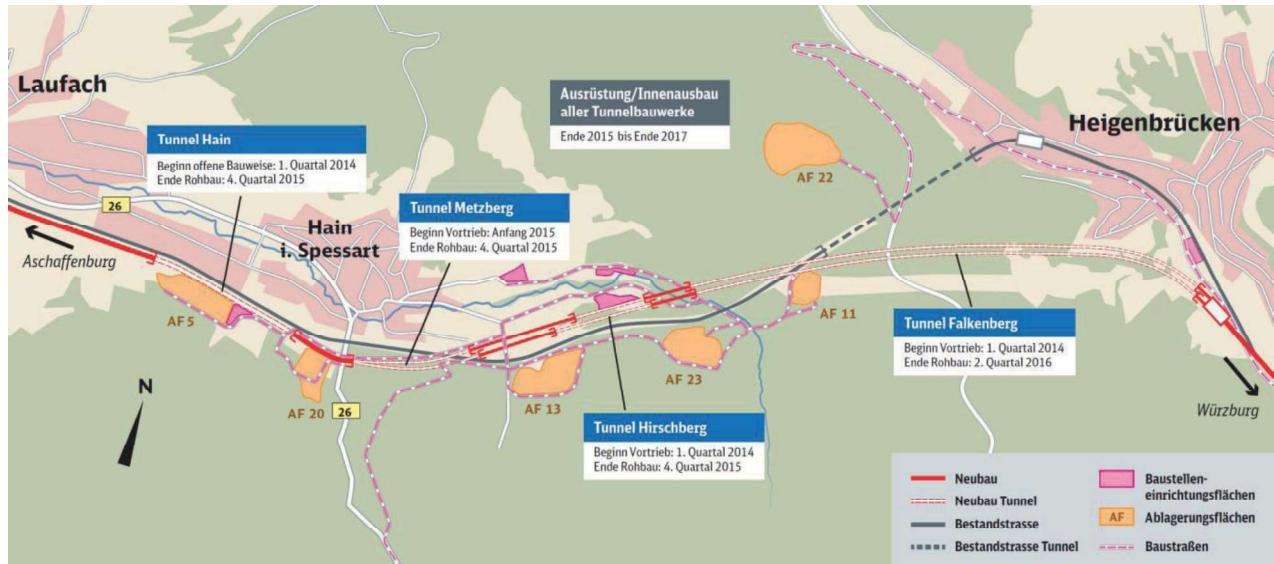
Lageplan der Bauwerke im Streckenabschnitt Laufach-Heigenbrücken (aus: DB Projekt GmbH, 2013)
